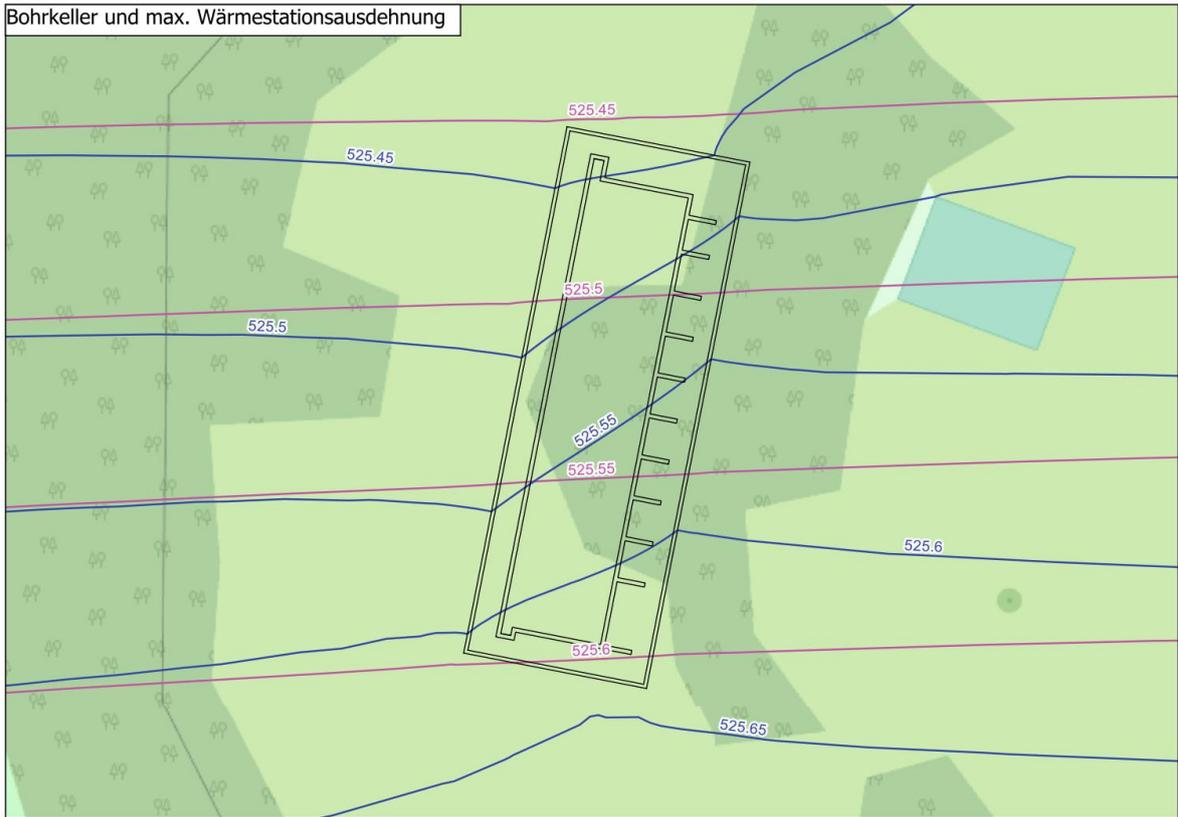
Bohrkellerbauwerk – Grundwassergleichen Mittelwasser ohne (lila) und mit (blau) einbindendem Gebäude; Wärmestation maximale Ausdehnung
